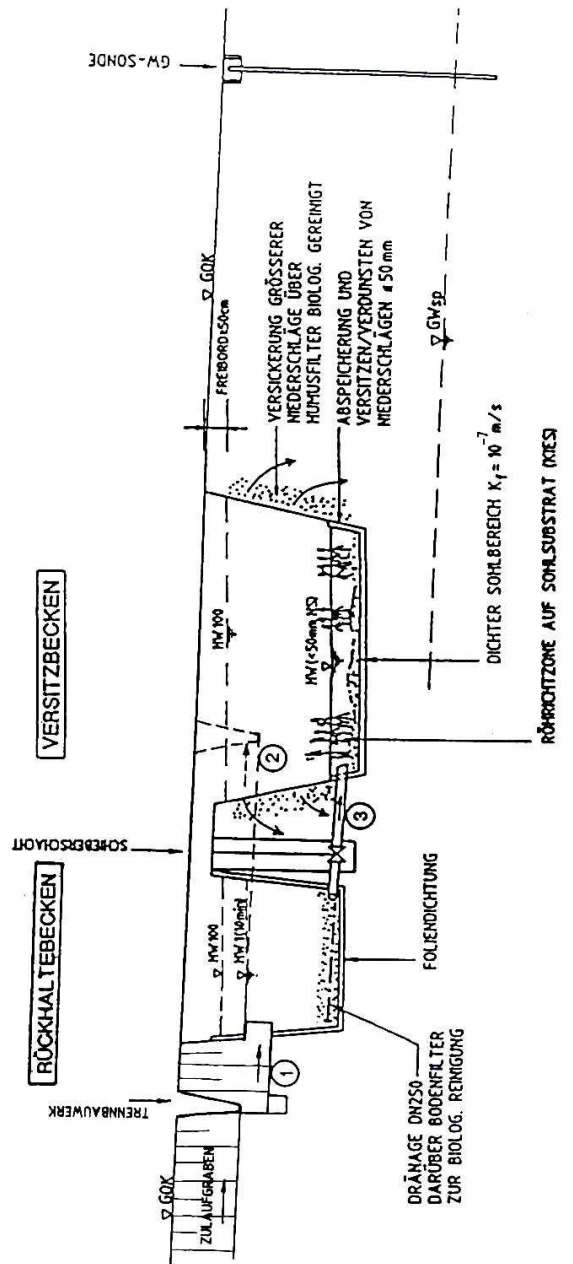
Funktionsschema Versitzbecken mit vorgeschaltetem Rückhaltebecken
